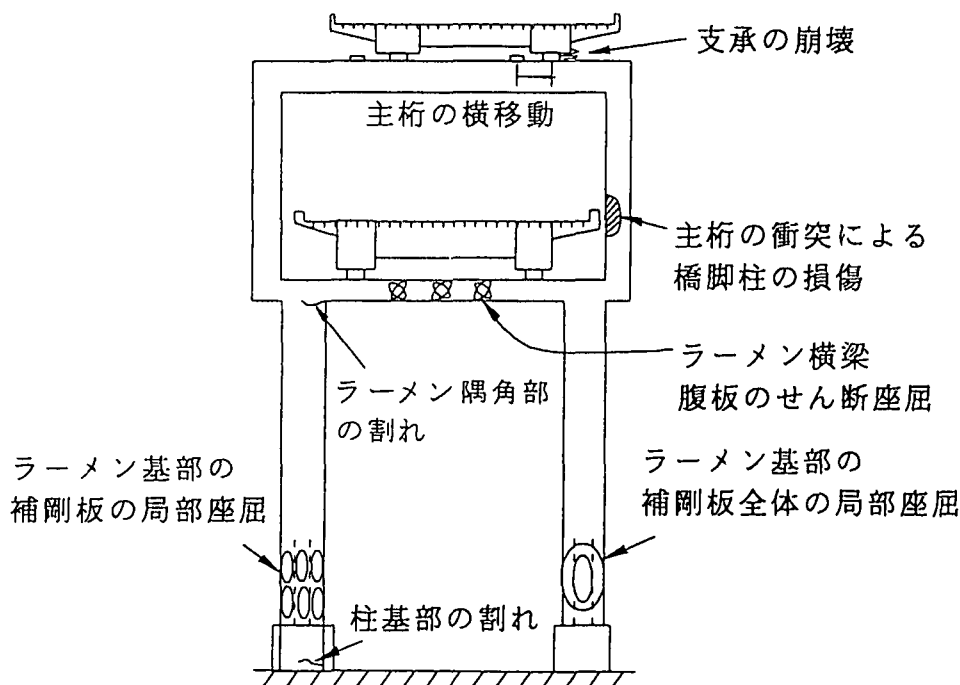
鋼製ラーメン橋脚の代表的な損傷のイメージ図
